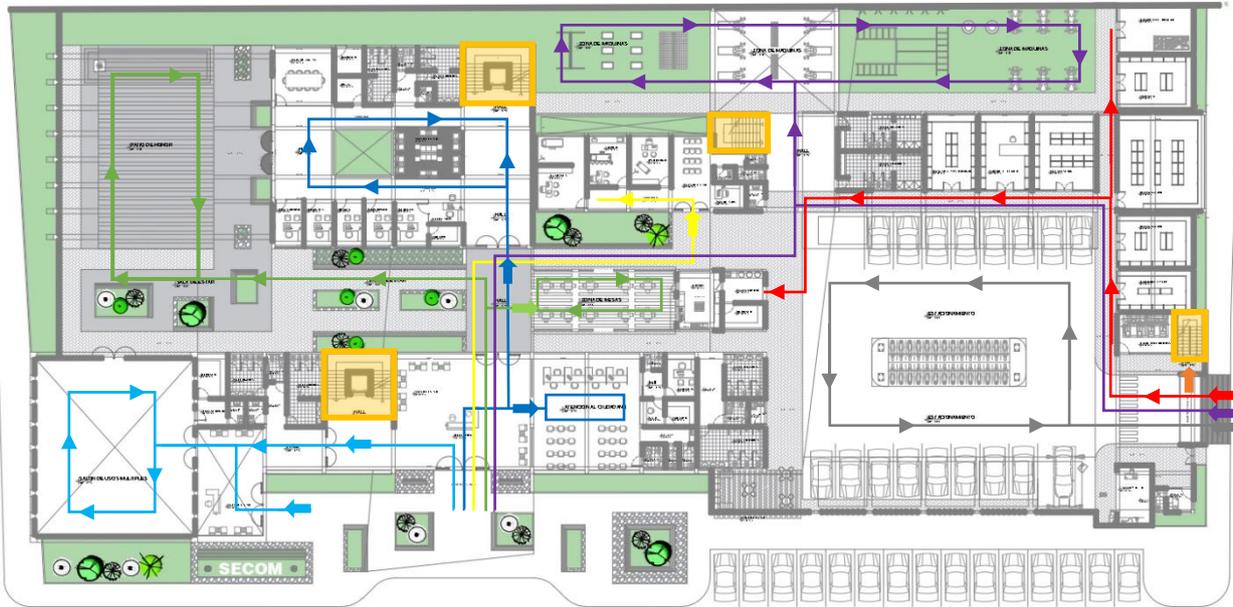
Circulación y Accesos - Primera Planta, SECOM
